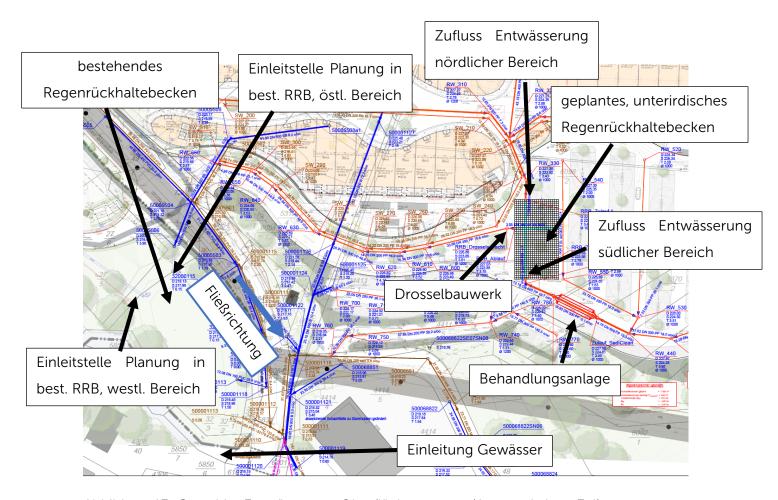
Grundriss Entwässerung Oberflächenwasser (Auszug Anlage 3.4)
